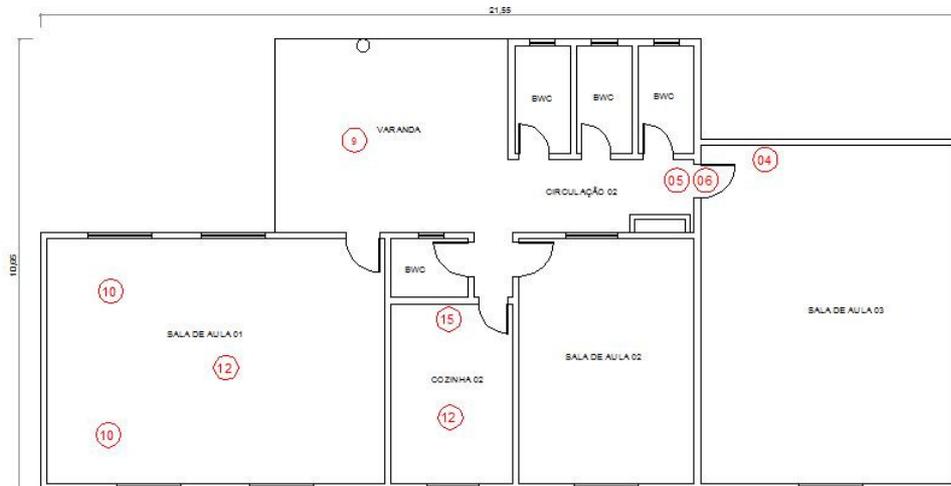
Planta Baixa Superior creche Favinho de Mel – 1 de Maio
